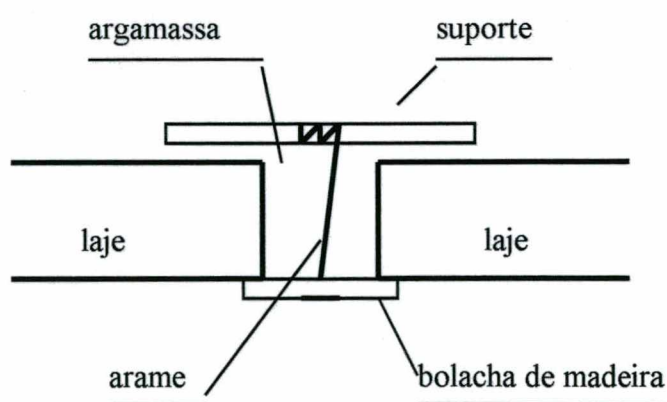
Esquema para vedação dos furos na laje de concreto
